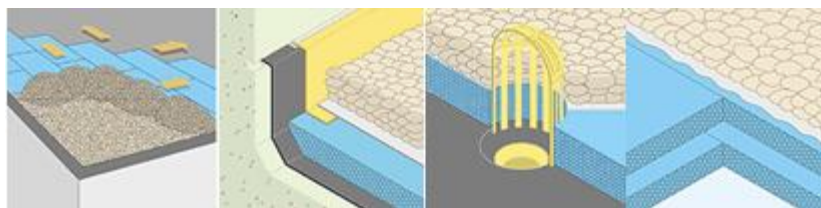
Exemplo de aplicação do Roofmate SL-A, Dow [39]
